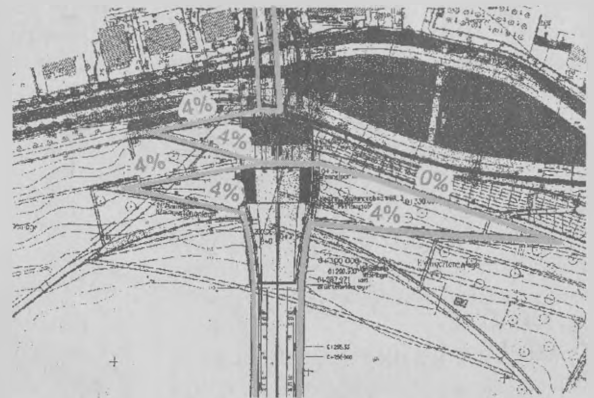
Verbindung Brücke - Bautzner Str. gemäß Planung
